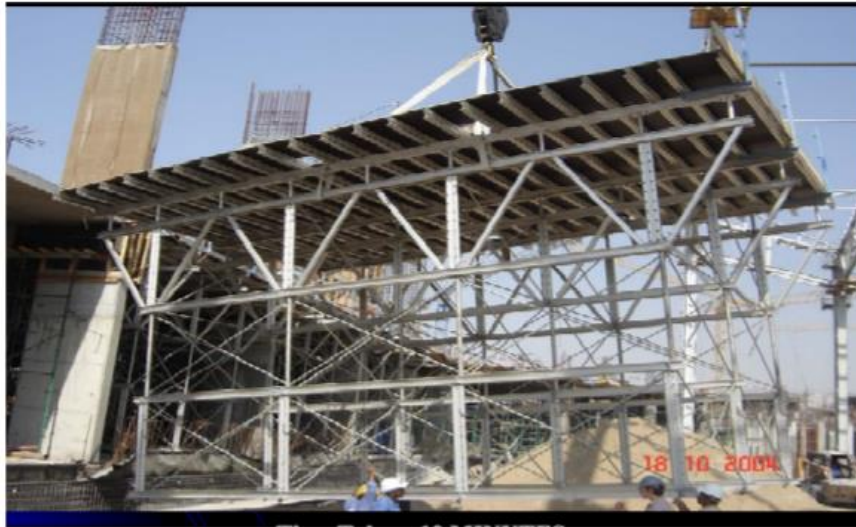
Алюмінієва опалубочна система для зведення плит перекриття будівлі
